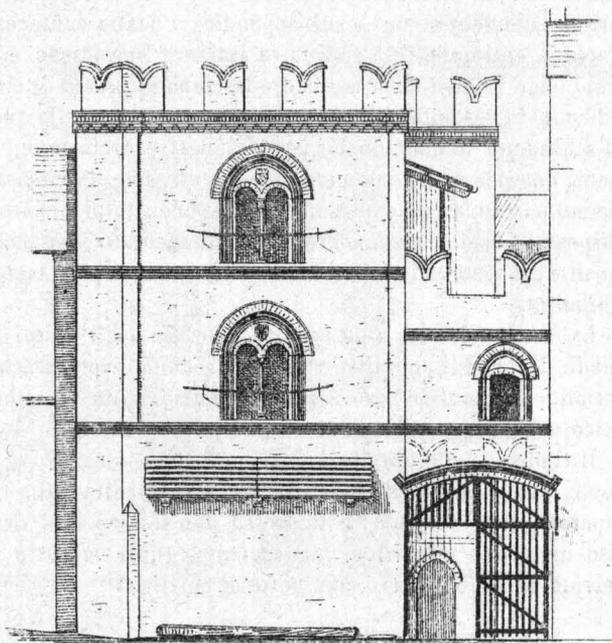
Prospetto della casa di Chieri (1 a 200).
